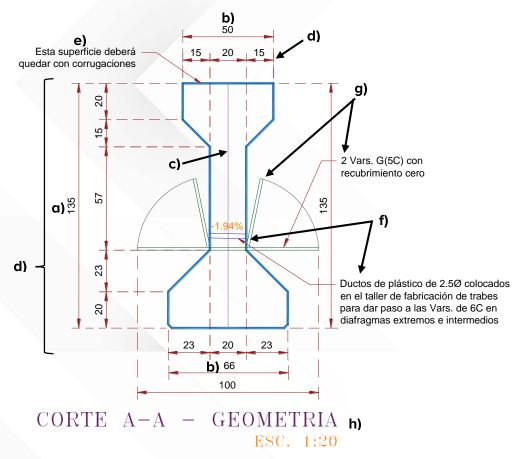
ejemplo de corte transversal de la trabe (geometría)
